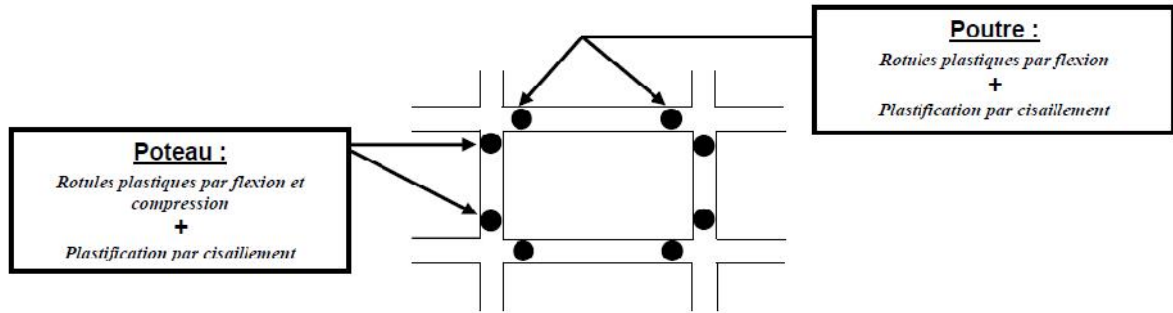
Rotules plastiques attribuées aux poutres et aux poteaux du portique
